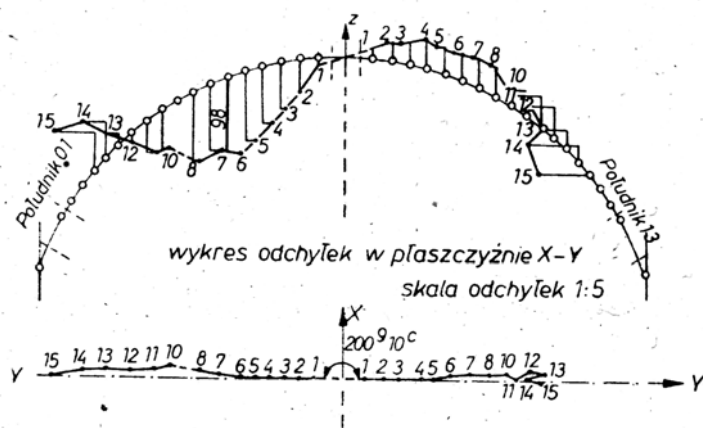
Konstrukcja dachowa hali przemysłowej
